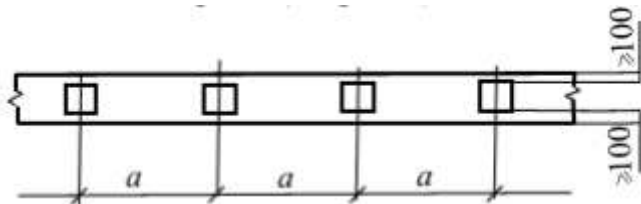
Схема расположения свай в рядовом фундаменте
